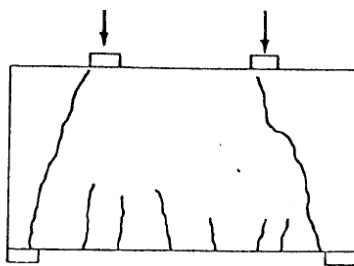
Ruptura por tração diagonal em uma viga biapoiada (MELO, 1984).
